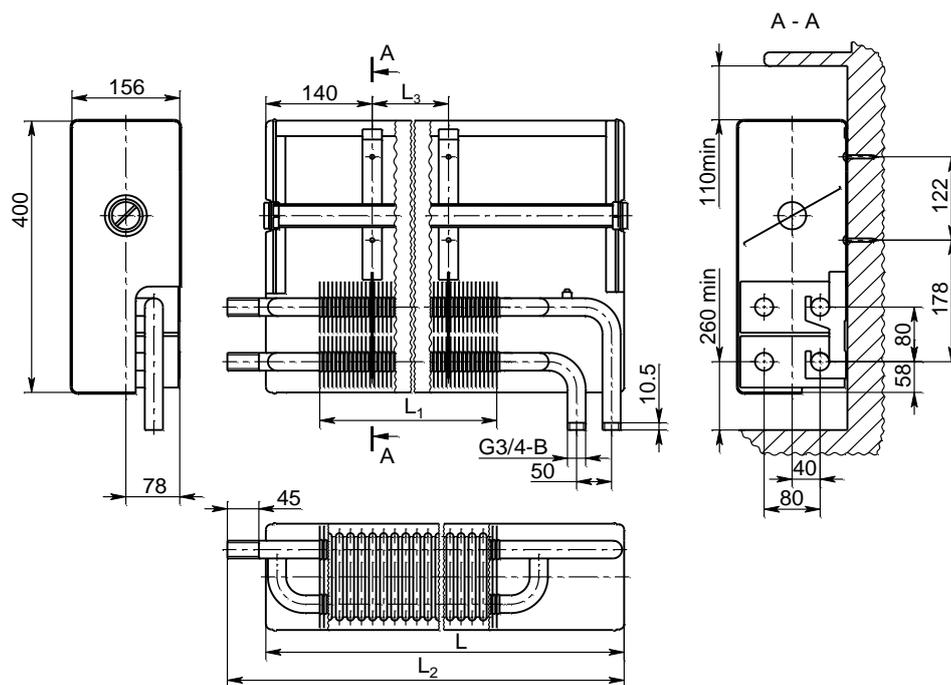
Конвектор «Универсал КНУ-С НП» средней глубины, с «воздушным» клапаном, проходной, с нижними присоединительными патрубками (табл. 1.12)
